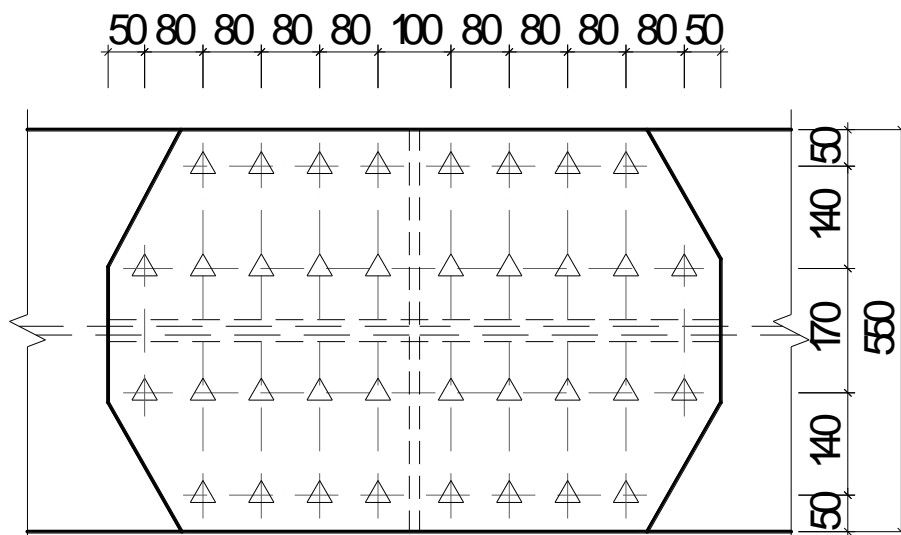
Размещение высокопрочных болтов на стыке поясов главной балки
